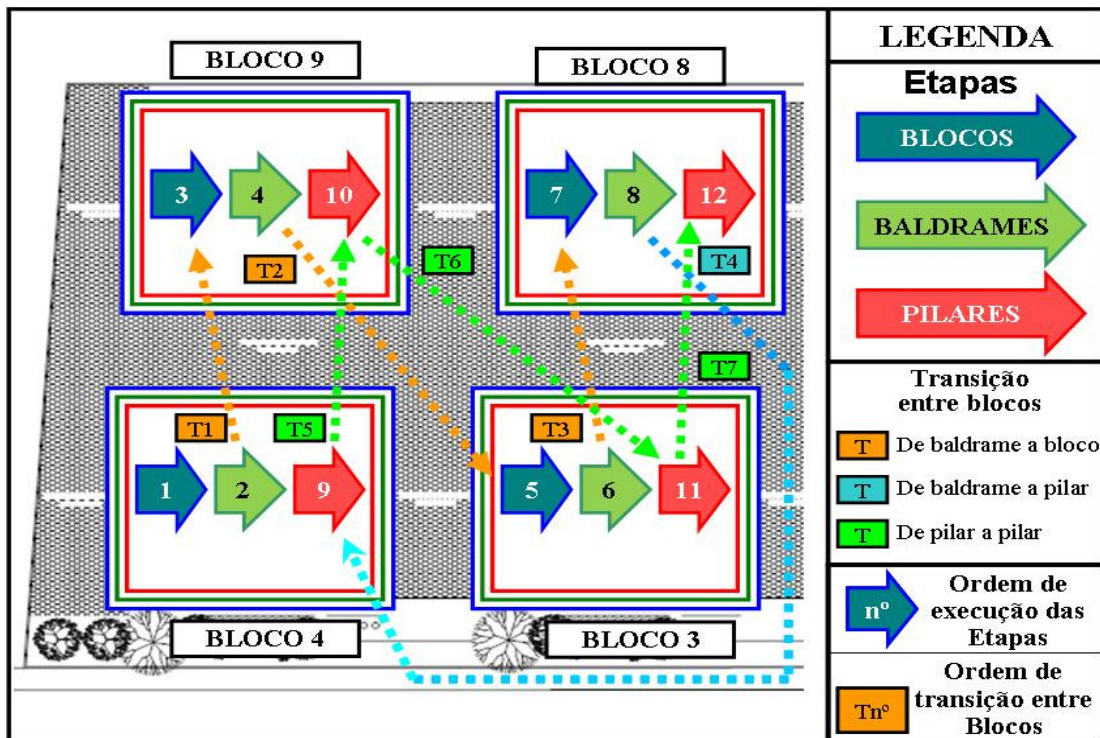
Detalhamento de movimentação da equipe no Plano Tático 1 – Etapas Blocos, Baldrames e Pilares do Pilotis
